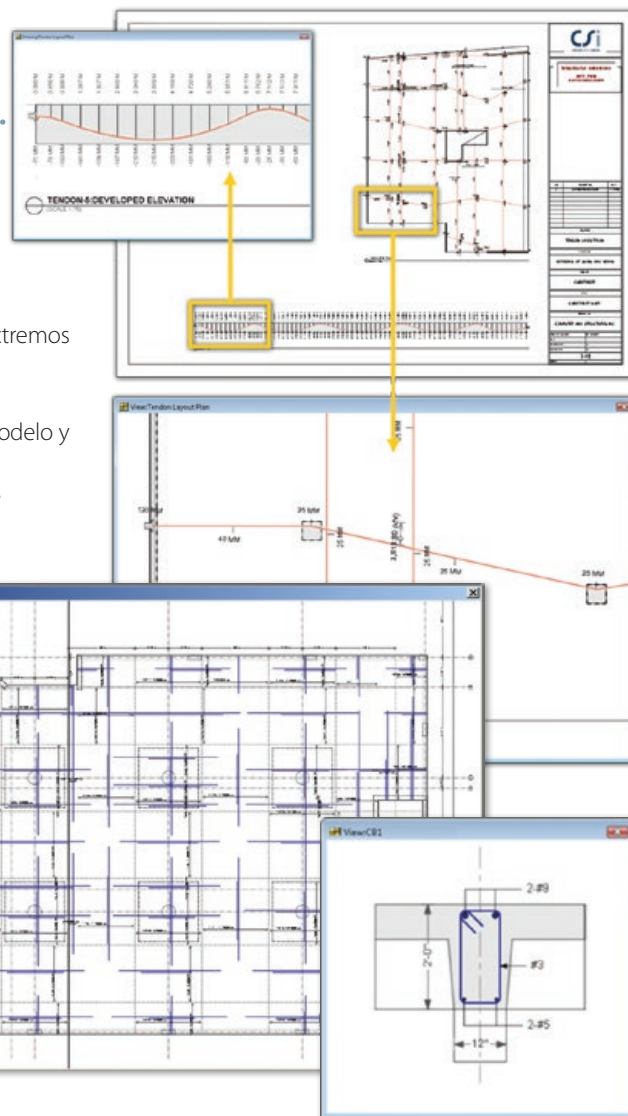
Detalle de armaduras y trazado de los cables en losas postensadas
